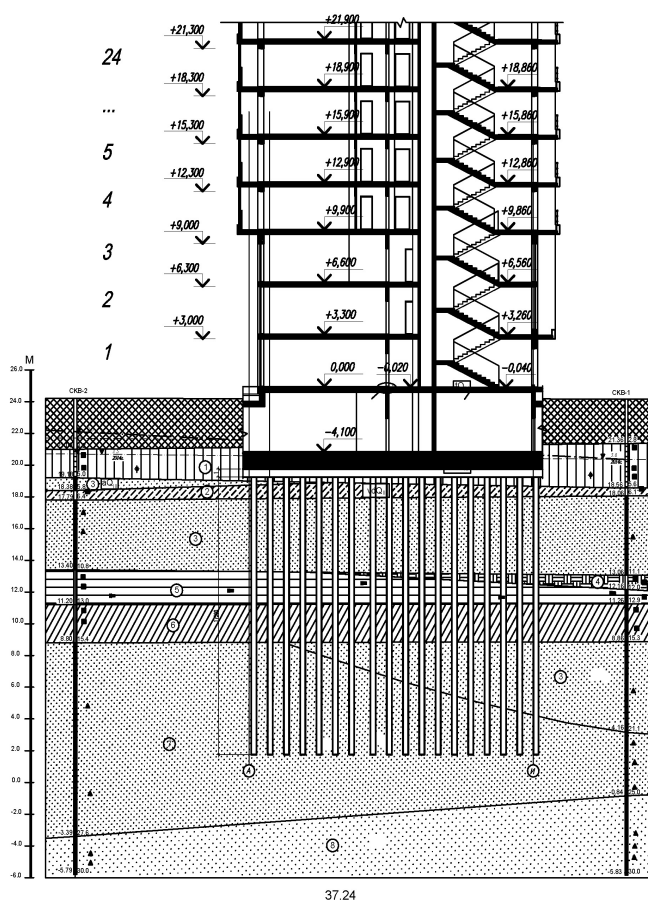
Грунтовые условия площадки строительства 25-этажного жилого дома по ул. Монтажников в г. Краснодаре
